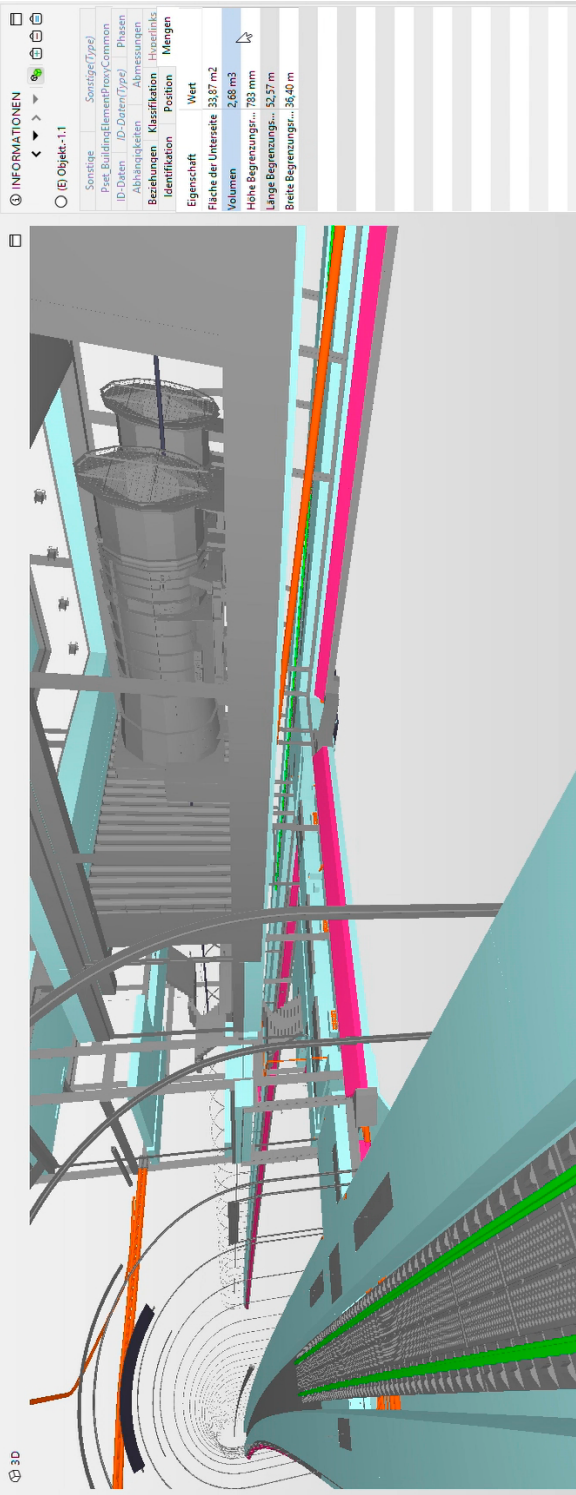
Planungs-Modell eines Eisenbahntunnels und Lüftergebäudes [8]
